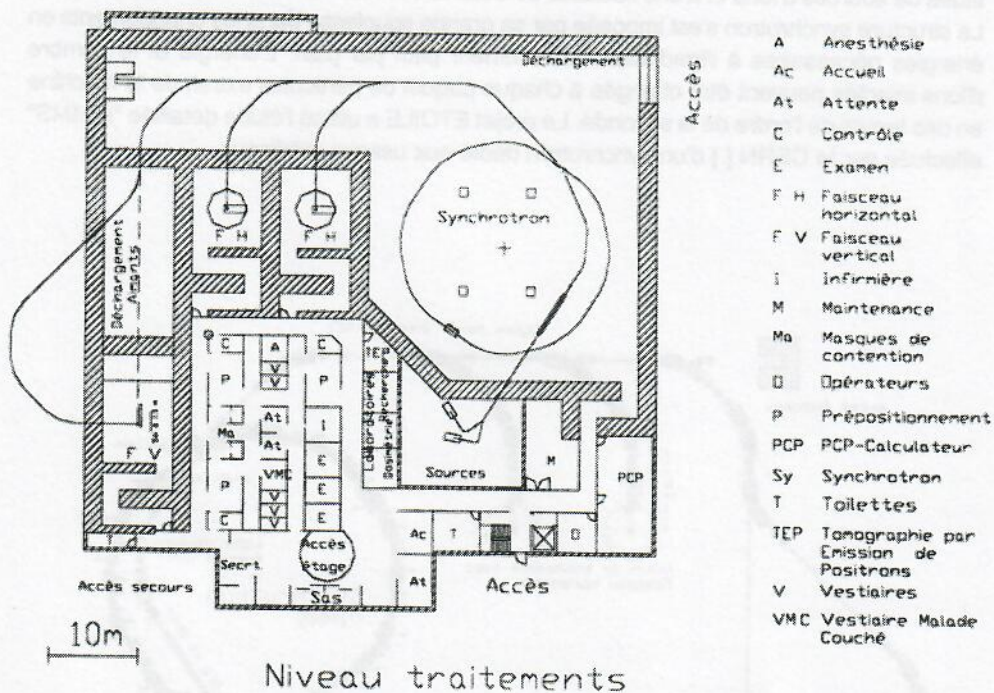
plan du niveau "traitements" du bâtiment ETOILE
